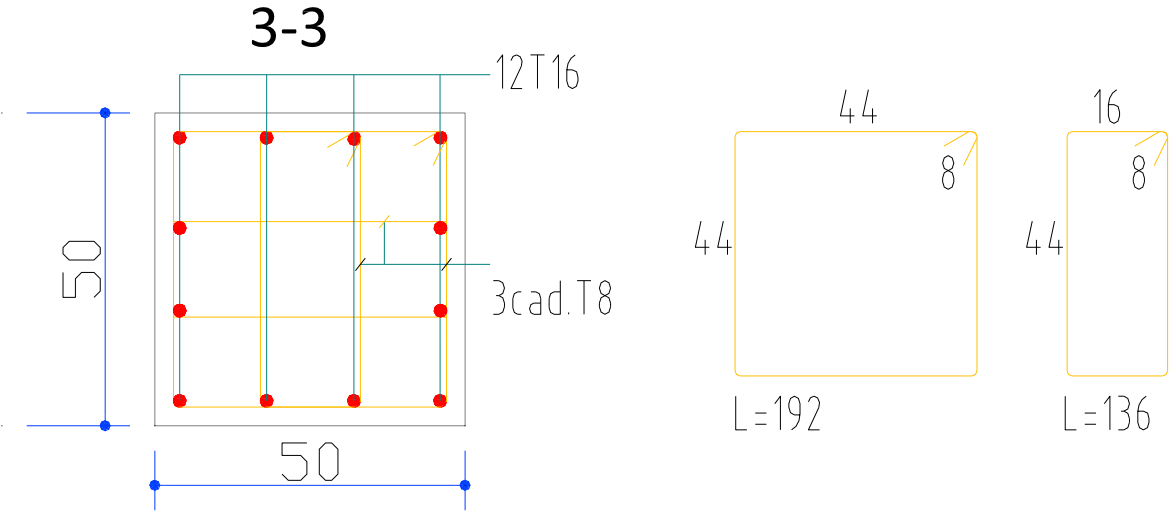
Coupe de ferrailage des poteaux 50 x 50 cm².
